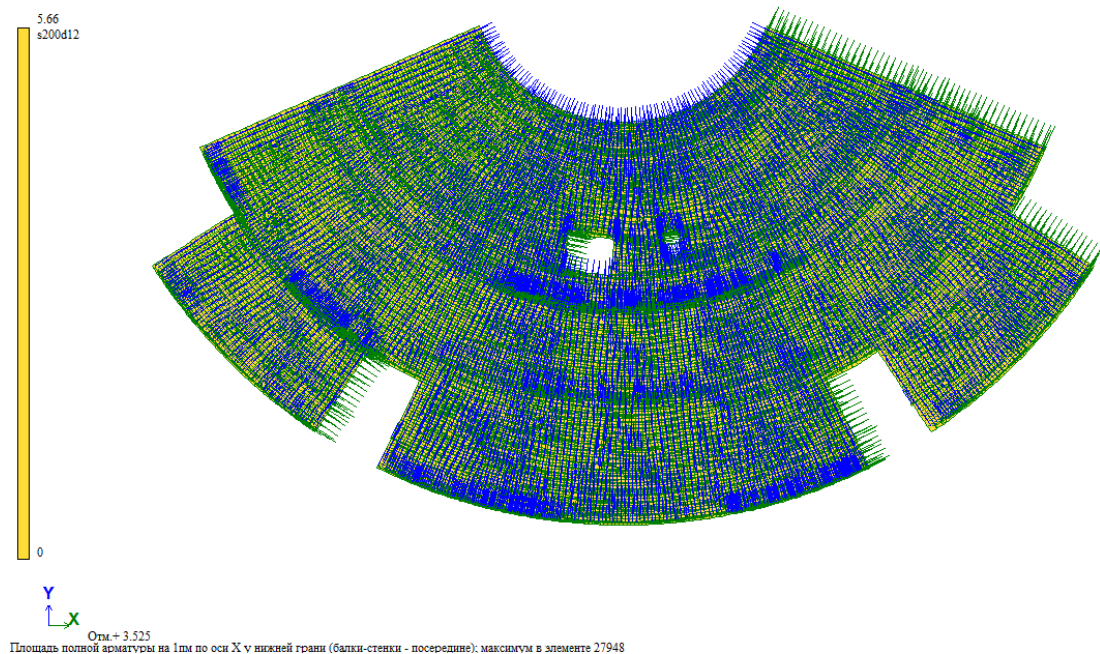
Площадь арматуры на 1м по X у нижней грани
